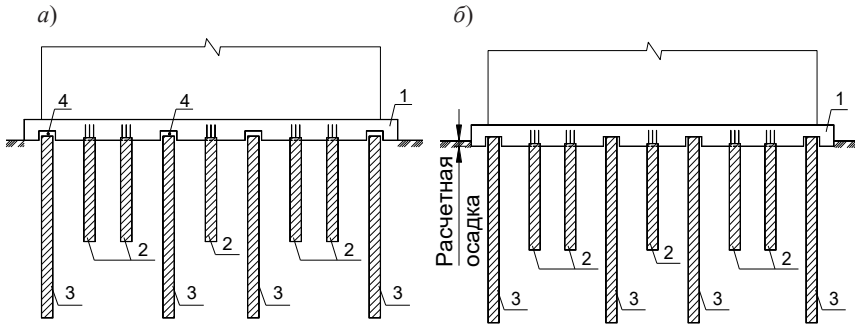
Способ строительства свайно-плитных фундаментов в сейсмических районах: а) начальный этап развития деформаций – осадка плиты с короткими, жестко заделанными сваями; 1 – фундаментная плита; 2 – короткие сваи, жестко заделанные в плиту; 3 – длинные сваи, отделенные от плиты расчетным зазором 4; б) конечный этап развития деформаций – вовлечение длинных свай в работу свайно-плитного фундамента (патент РФ № 2300604)
